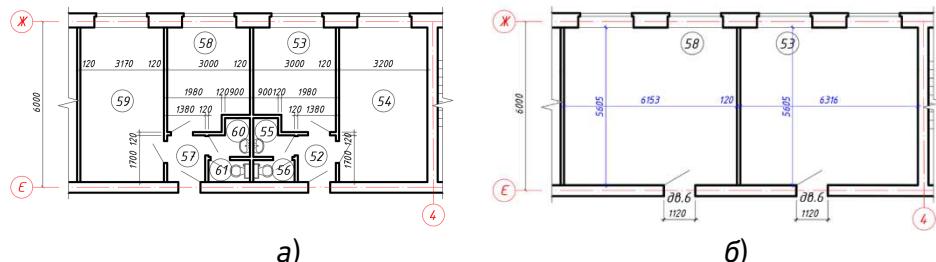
Перепланування житлових кімнат: а) фактичне плануванльне рішення; б) проектне рішення
